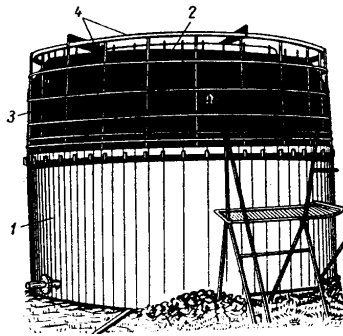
Резервуар з еластичним корпусом: 1 – корпус металевий; 2 – дах; 3 – еластична стінка з прогумованої тканини; 4 – каркас
